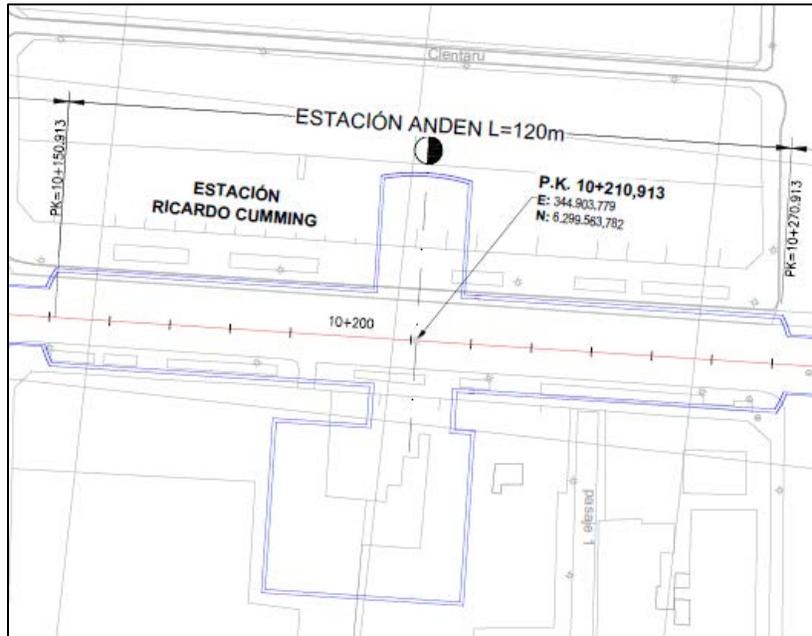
Planta Emplazamiento Pique Estación Cumming
